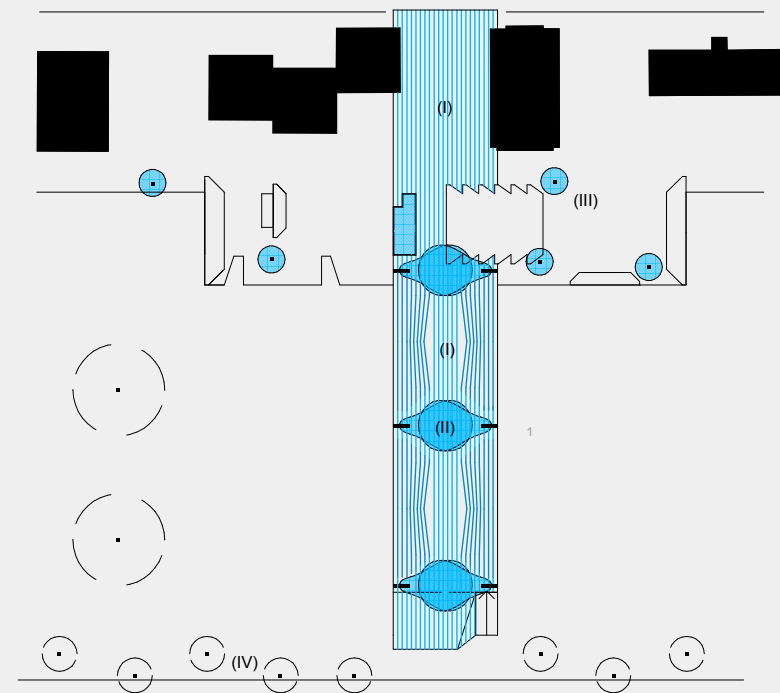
Beleuchtungskonzept Grundriss
